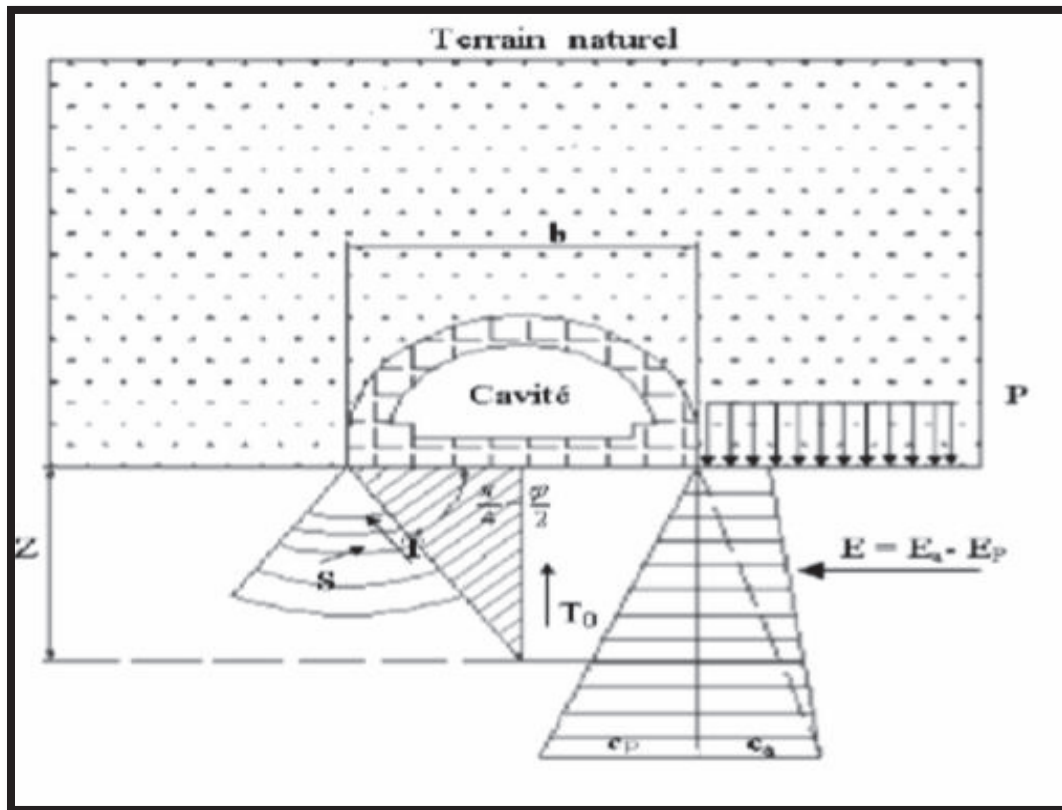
La poussée au niveau de radier selon TSIMBRIEVITCH
